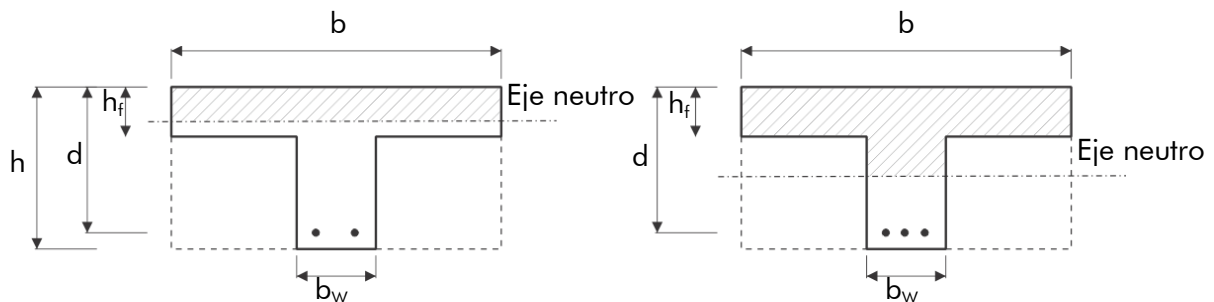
Posibles ubicaciones del eje neutro en vigas T
